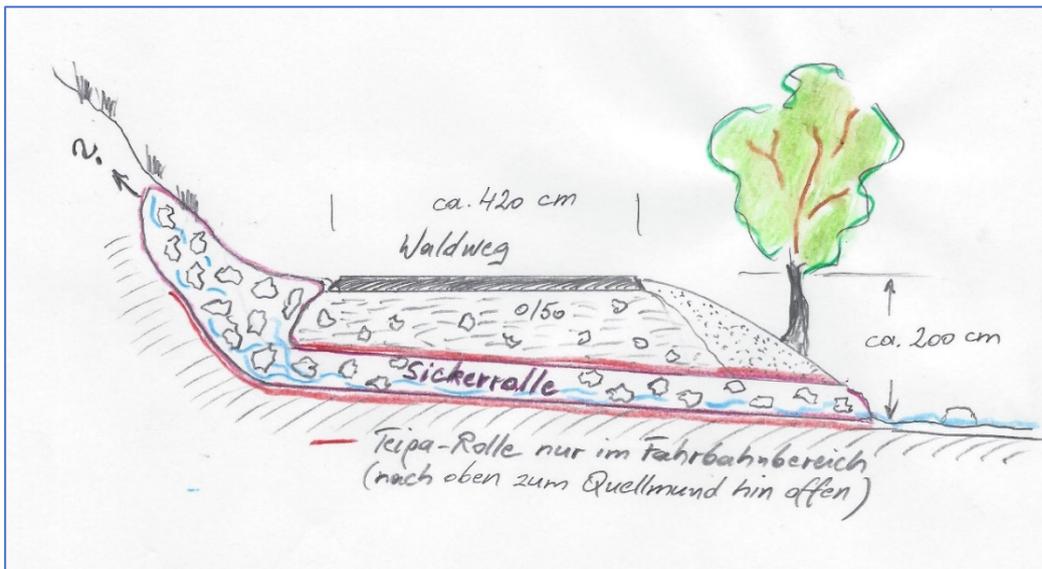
Beispiel einer Sickerrolle im Längsschnitt (Skizze Ä. Erpelding)
